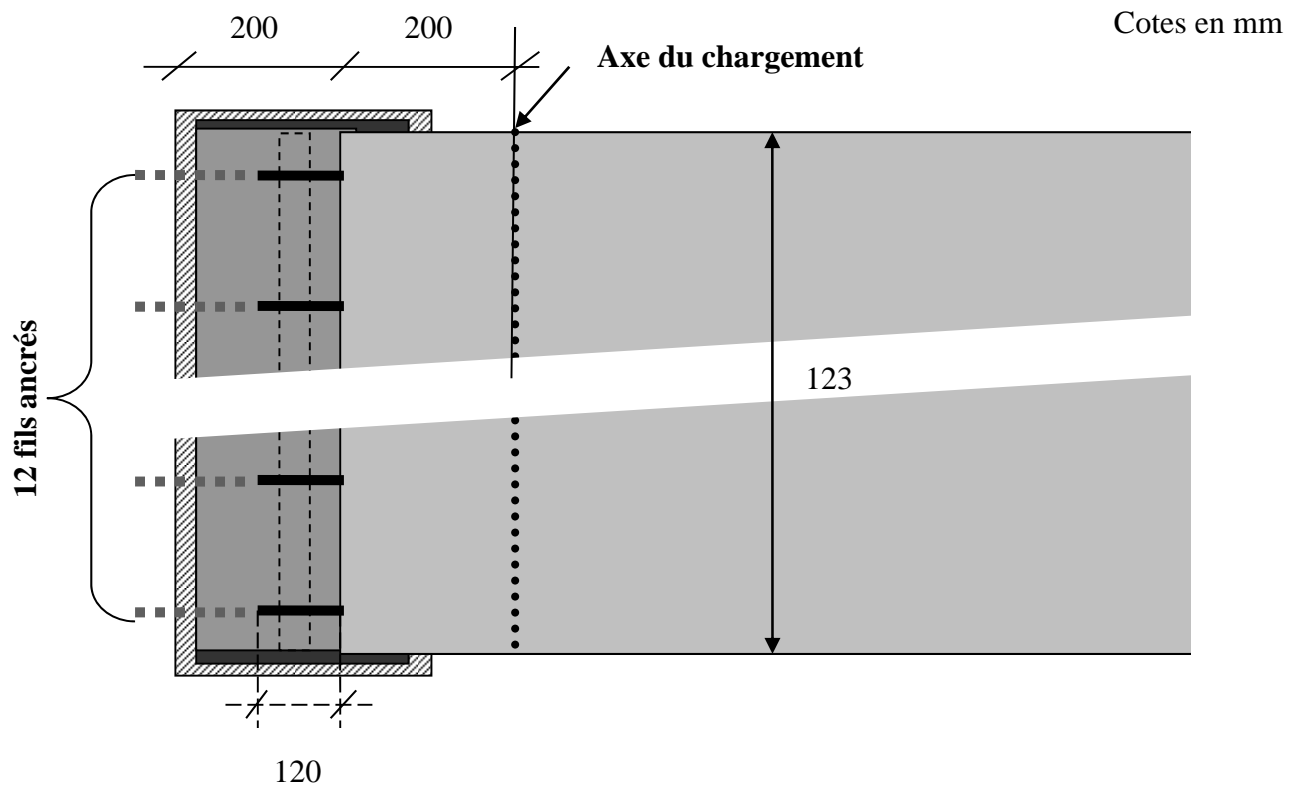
Vue en plan du montage de l'essai avec l'appui direct
